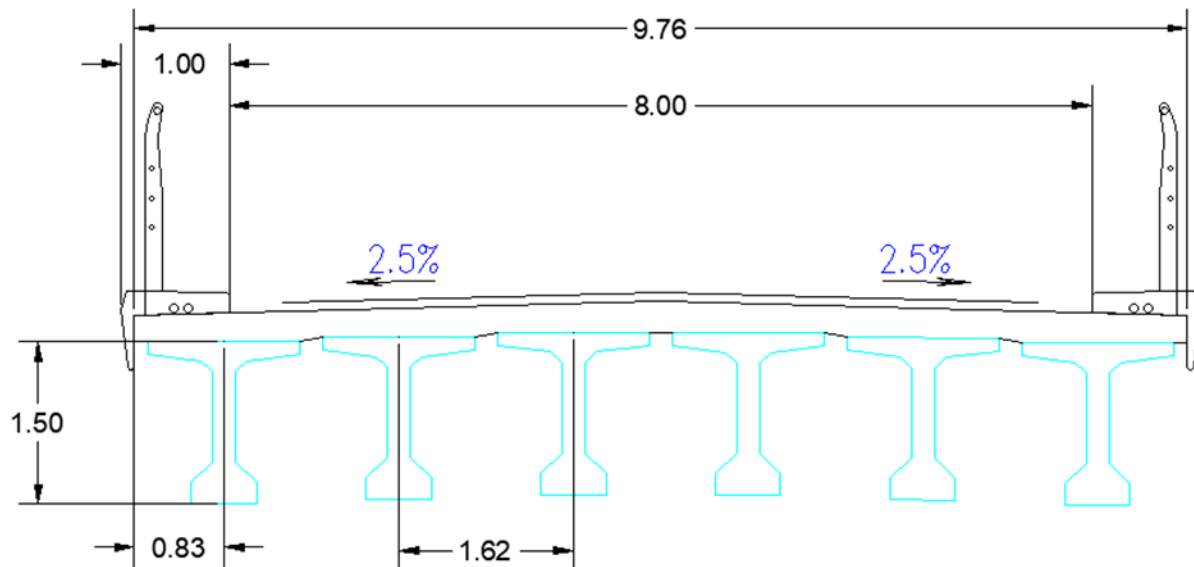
Coupe transversale sur le tablier à poutres en BP.
